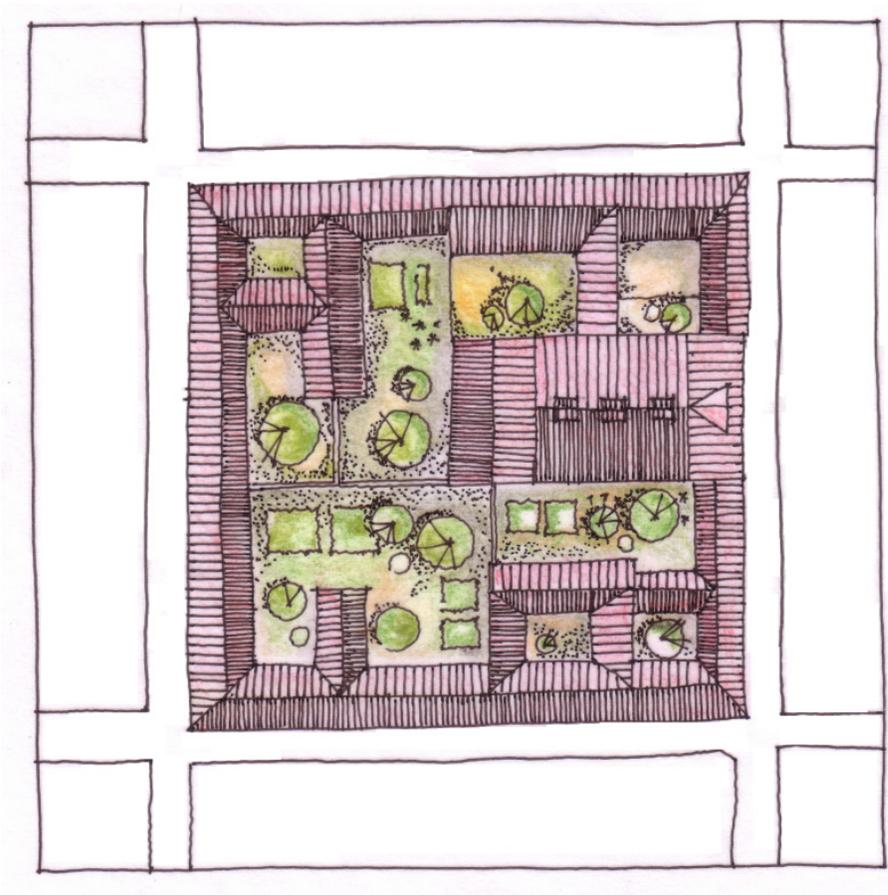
Plano de cubiertas de la manzana en la que se localizaba el Coliseo Ramírez. 1858.
